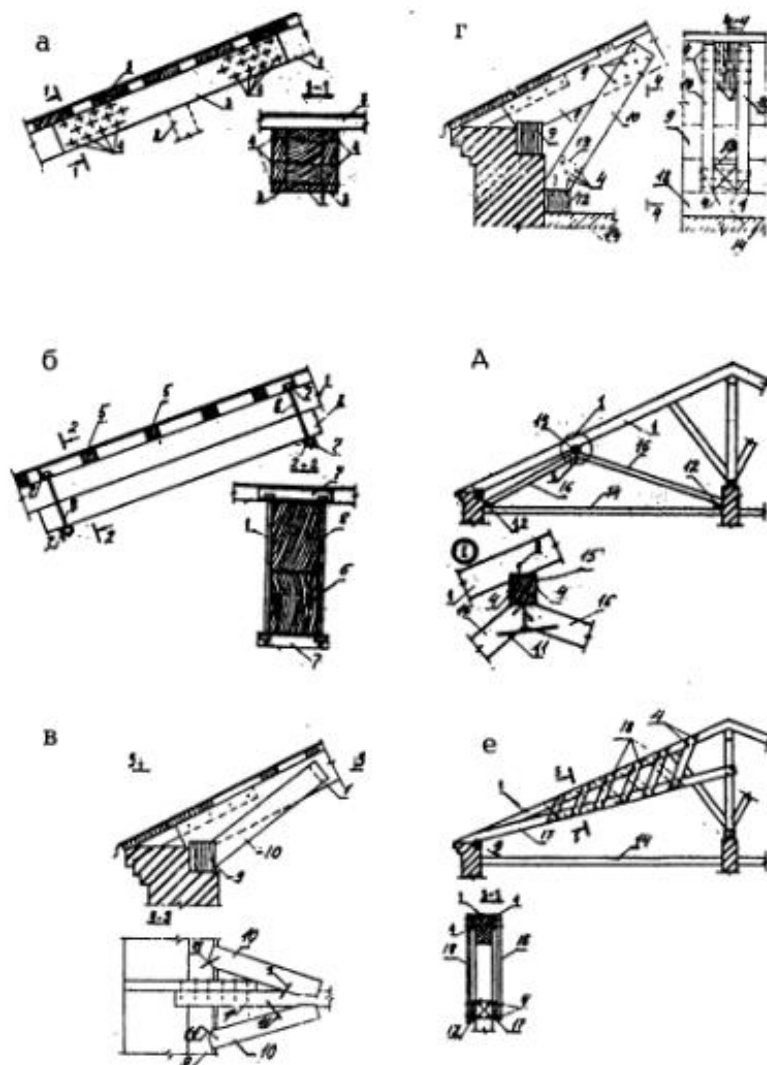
Усиление конструкций деревянных стропил: а – двухсторонними дощатыми накладками; б – разгружающей балкой; в – подкосами, опертymi на мауэрлат; г – подкосами, опертymi на чердачное перекрытие; д – разгружающими подкосами; е – устройством фермы с перекрестной дощатой стенкой; 1 – усиливаемая стропильная нога; 2 – временный разгружающий подкос для устранения прогиба стропильной ноги; 3 – деревянные накладки; 4 – гвозди; 5 – обрешетка; 6 – разгружающая балка; 7 – стальные уголки; 8 – стяжные болты; 9 – мауэрлат; 10 – подкос; 11 – стальная скоба; 12 – лежень; 13 – прокладка; 14 – чердачное перекрытие; 15 – разгружающая деревянная балка; 16 – подкосы; 17 – нижний пояс фермы из досок; 18 – решетчатая стенка из досок
